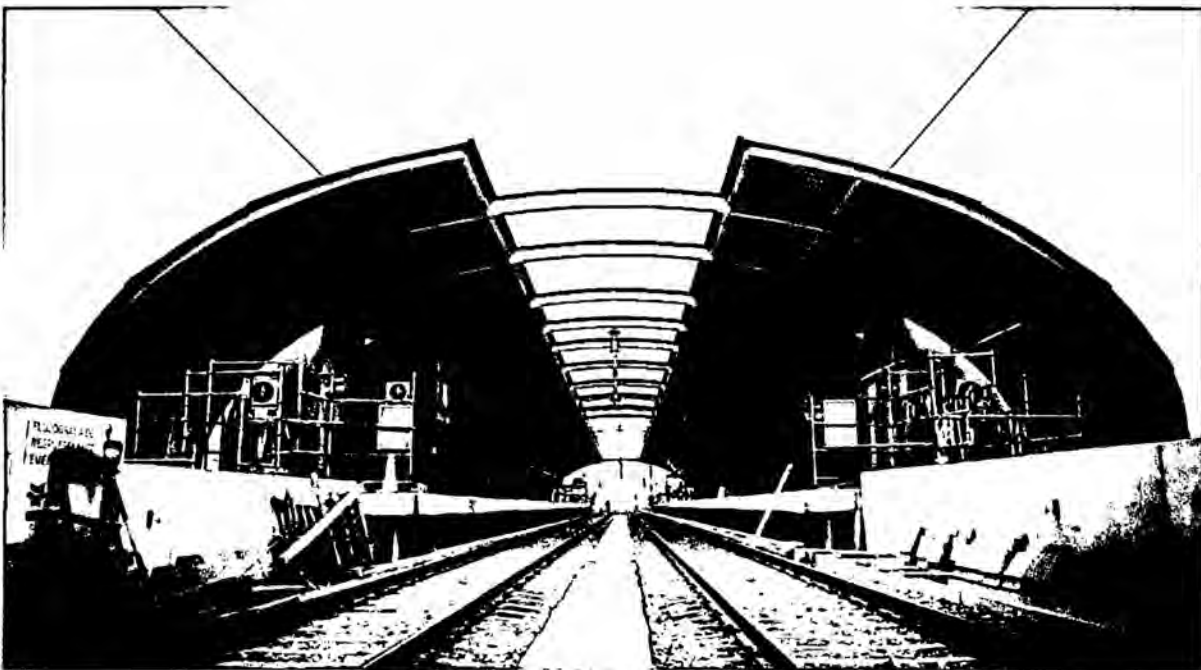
Fotografía – Montaje Finalizado Cubierta de Techo (Fuente: Tramo 2)
